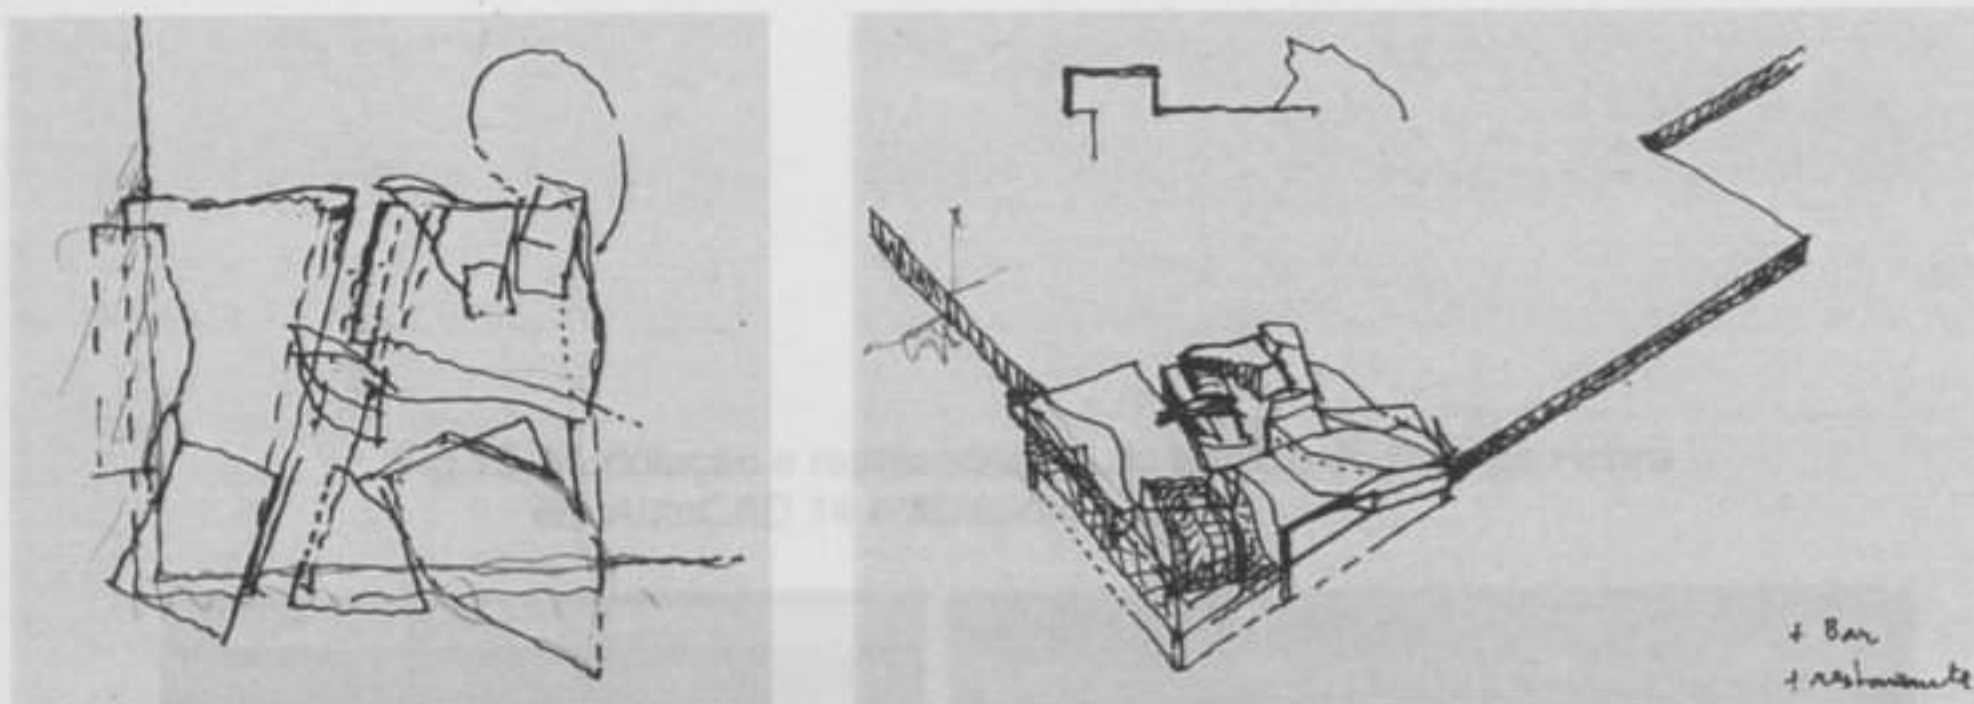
Planta e perspectiva do Prof. Arqº.Tomás Taveira
